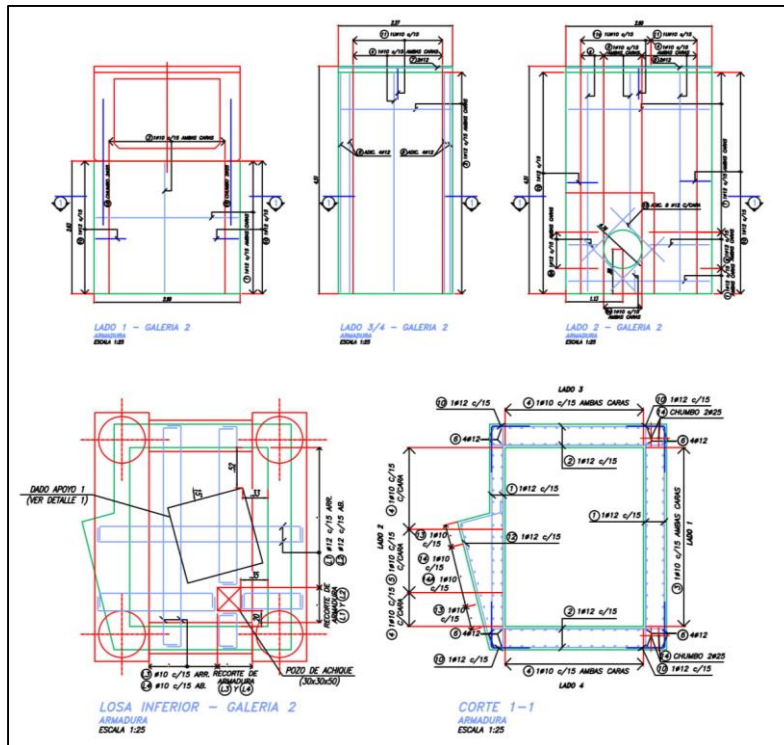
Detalle galería 2. (PLANO N° 30)
